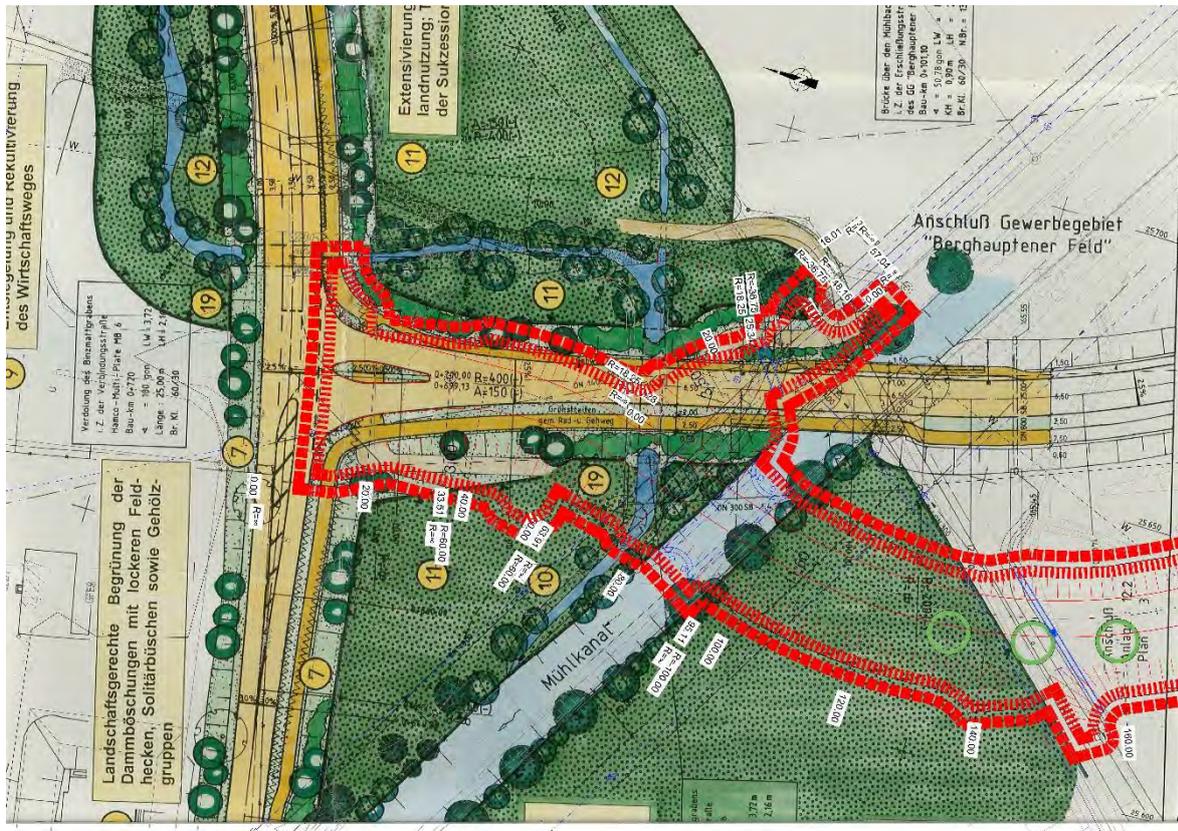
Planung Nordspange und äußere Erschließung Gewerbepark
